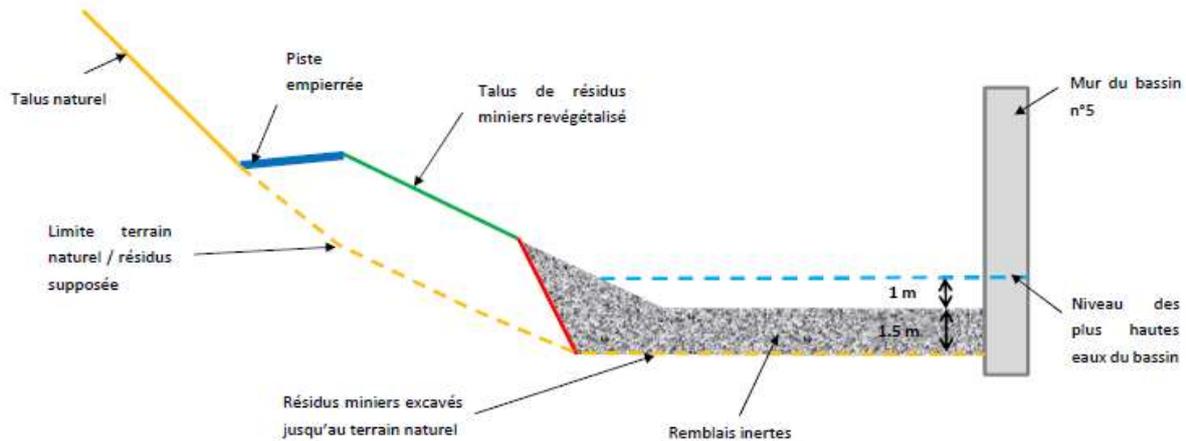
Coupe de principe du projet d'aménagement des bassins 4 et 5
